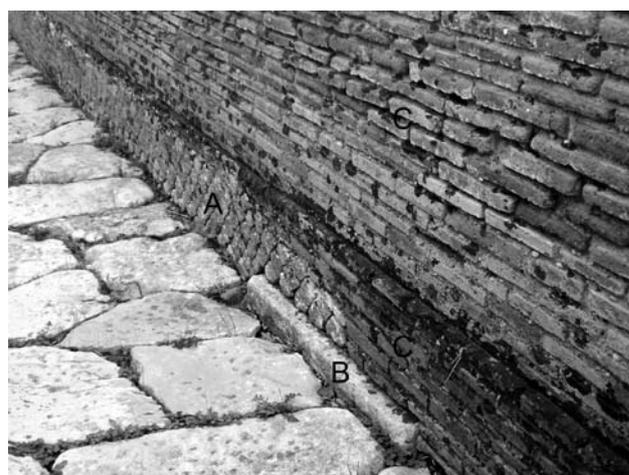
"Basilica". Particolare del muro perimetrale est, lato esterno. A. Muro di I fase; B. Blocco di pietra calcarea sull'angolo nord-est dell'edificio di I fase; C. Muro di II fase.
